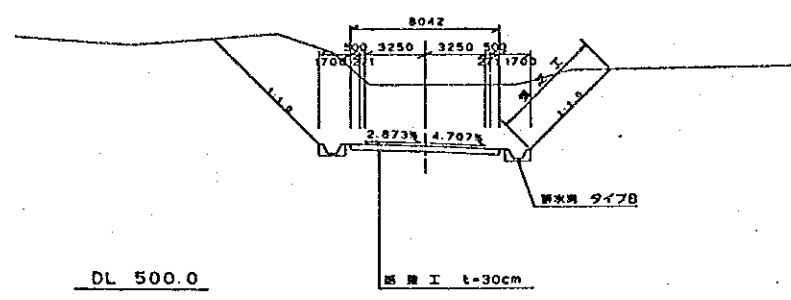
ガデウリ(Gadeuli)橋取付道路平面・断面標準横断面図
